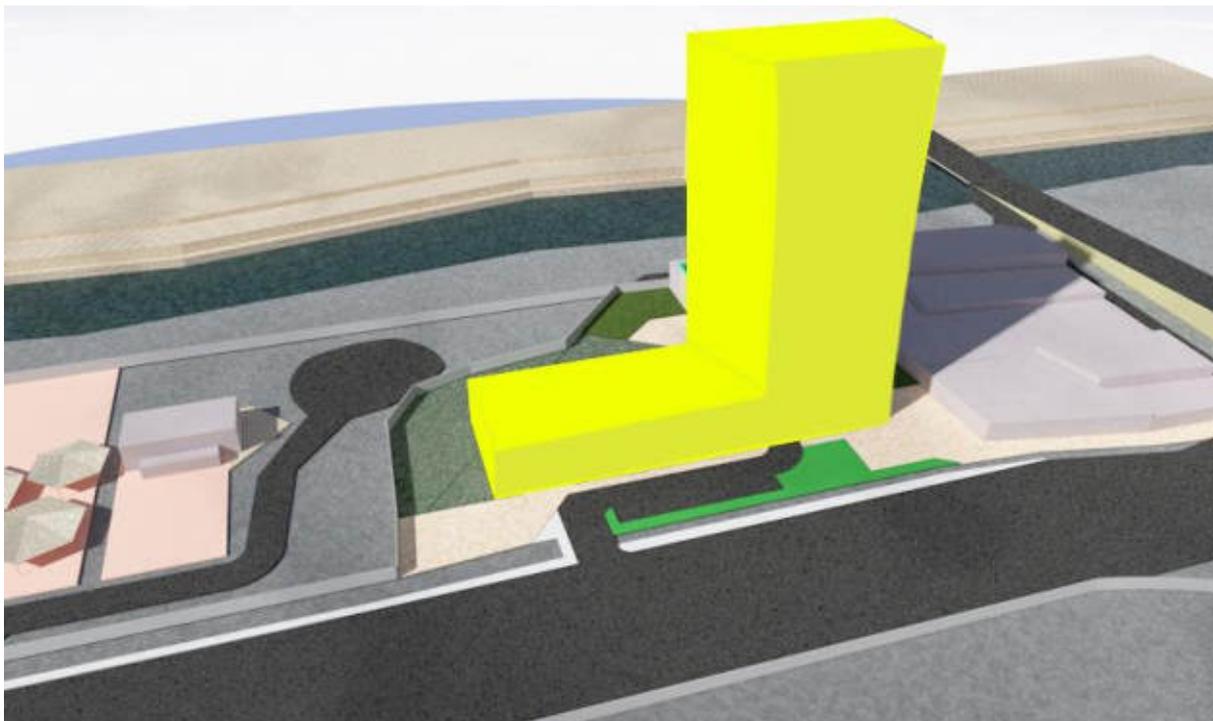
Premisa formal, Fuente: Elaboración propia.
